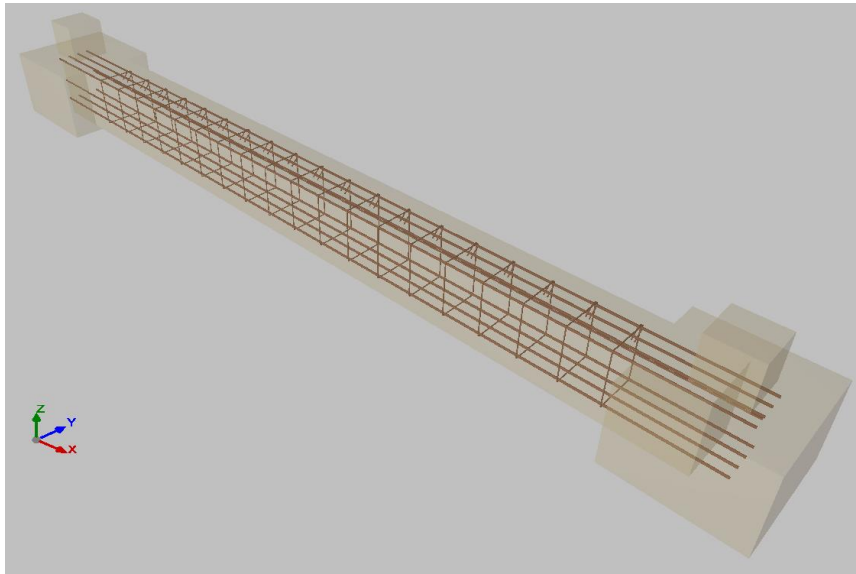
Perspectiva de una viga de atado (Fuente: CYPE 2019).
